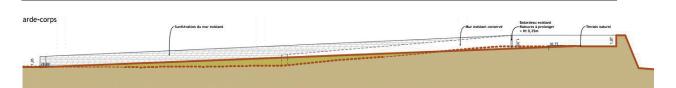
Modification de la rampe d'accès amont du quai Mayaud
